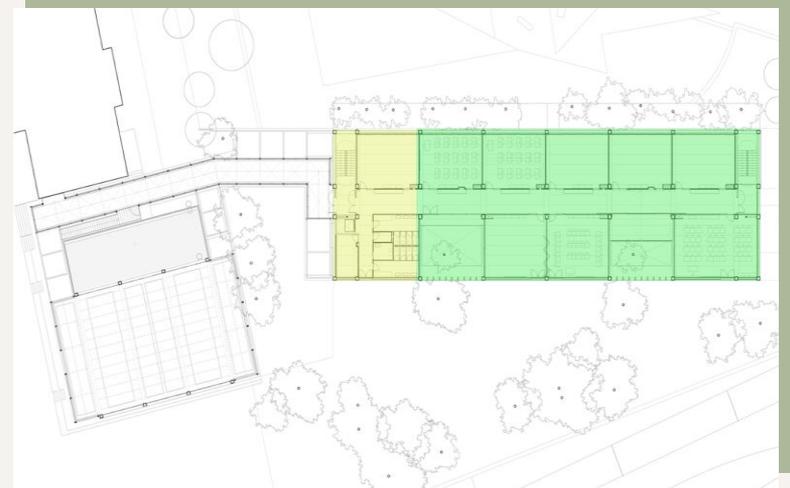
PLANTA 1º PAV. DO INSTITUTO BADIA I MARGARIT
